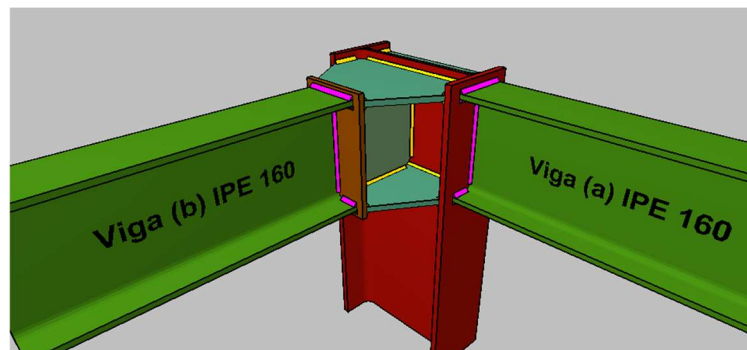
UNIÓN SOLDADA 1. FUENTE : CYPE 3D
